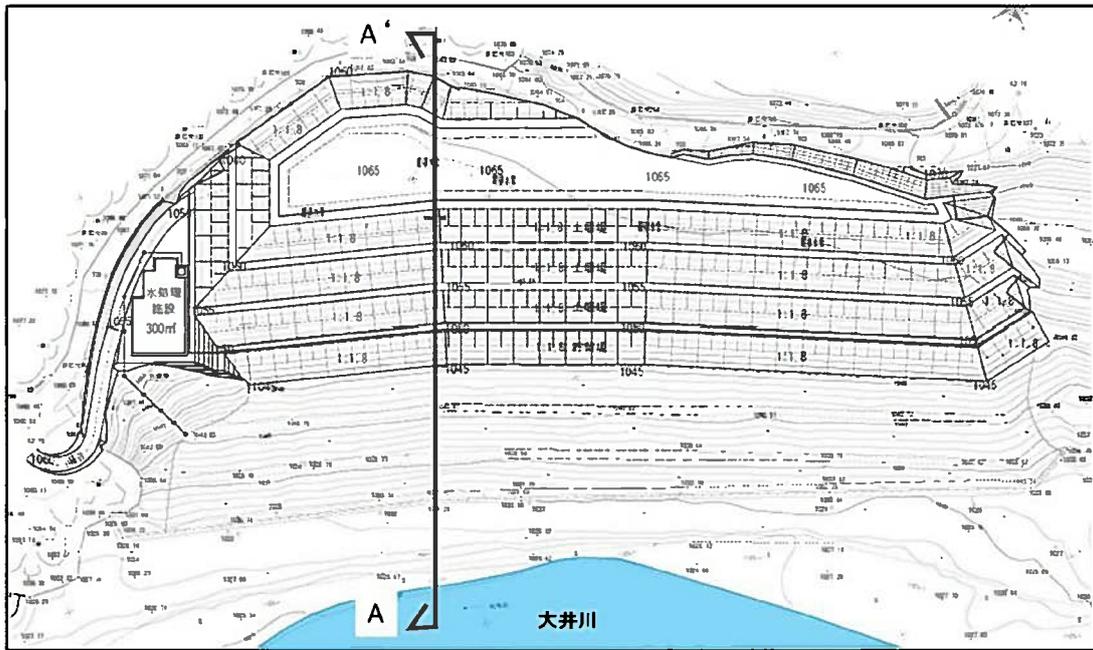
藤島沢付近の発生土置き場（遮水型）計画平面図
